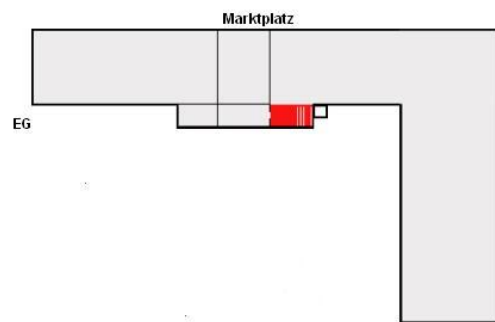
Grundriss der VBF Darmstadt⁸⁸
